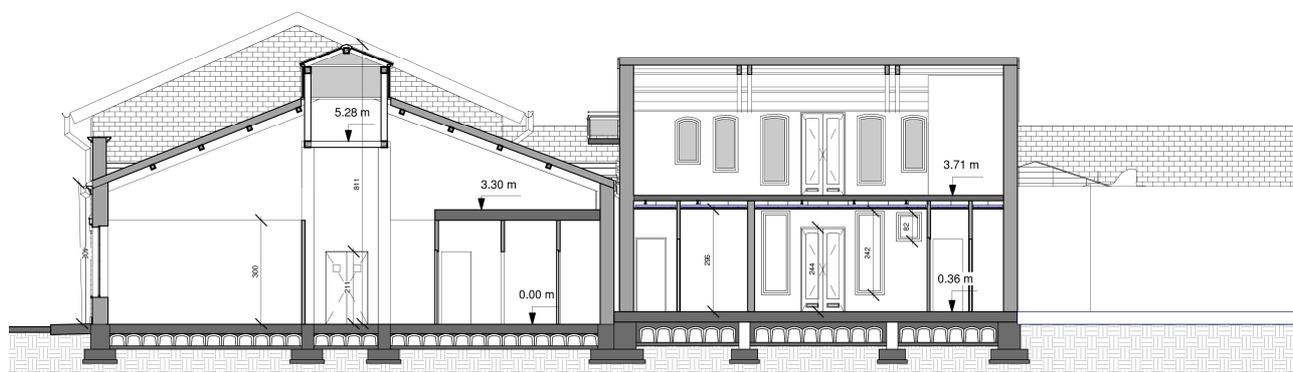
Sez. B-B (Tav. n° 9 scala 1:100)
